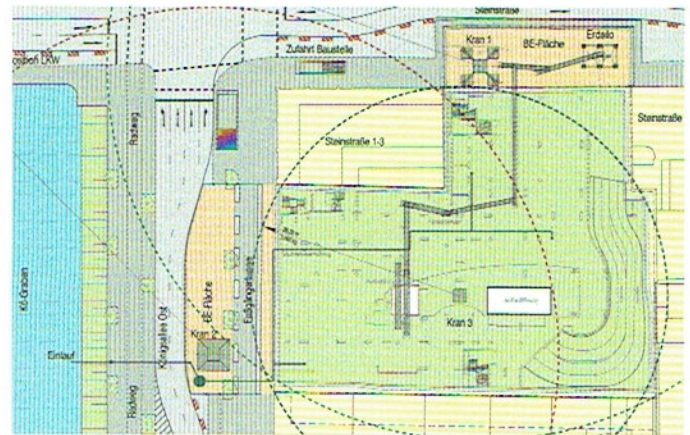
Lageplan mit Baustelleneinrichtung während der Aushubarbeiten unter dem Deckel
